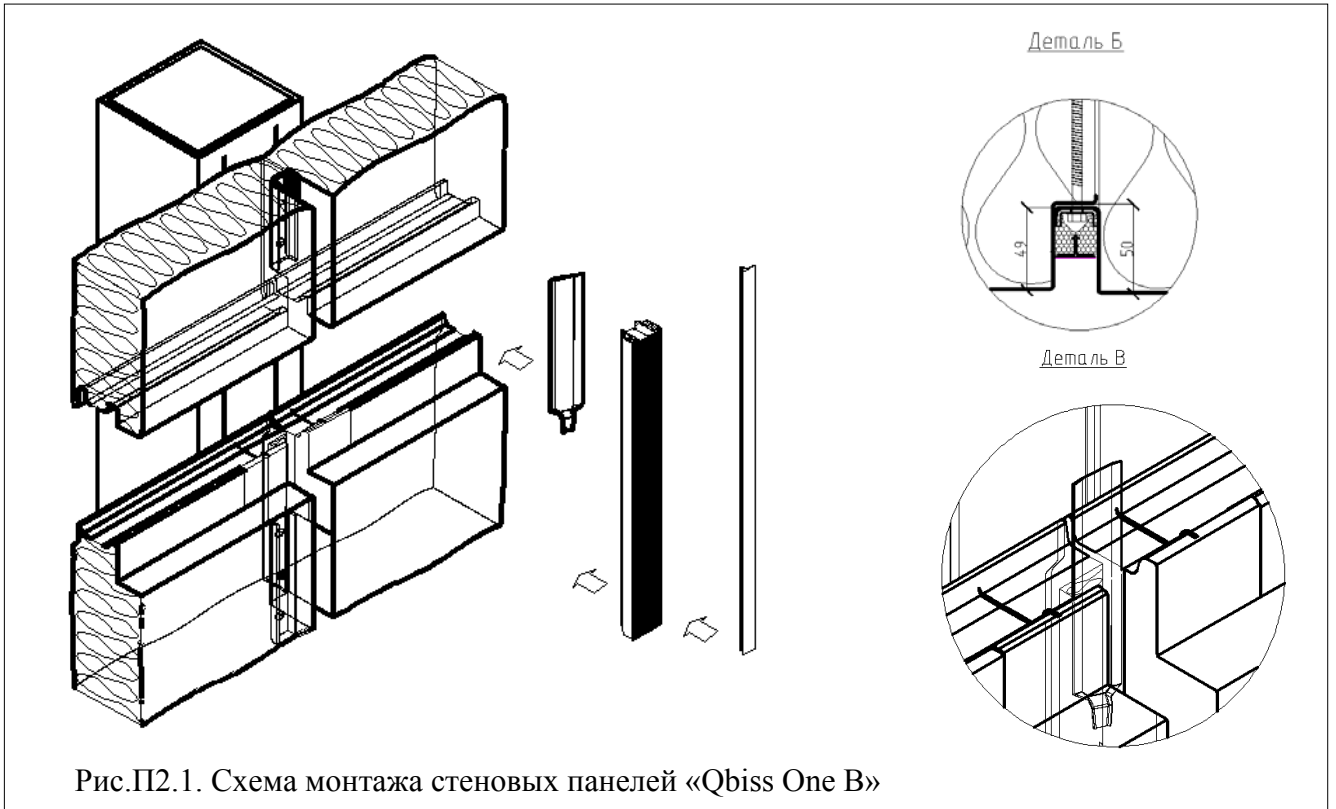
Схема монтажа стеновых панелей «Qbiss One B»
